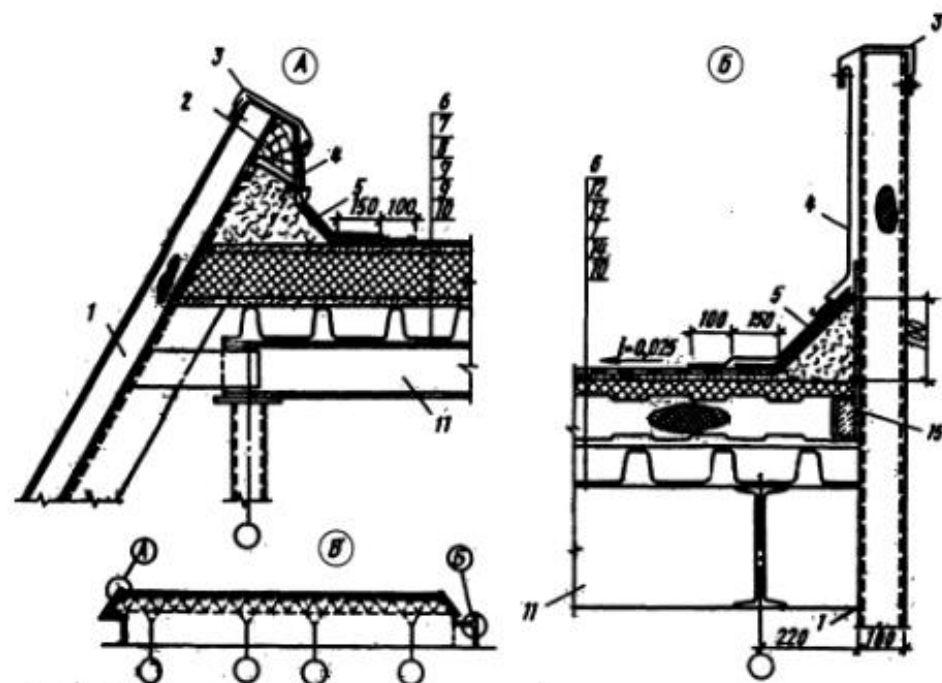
Узлы примыкания металлических панелей ограждения к конструкциям покрытия по структурной плите: А – наклонный фриз; Б – парапет вертикальной стены; В – схема покрытия; 1 – металлическая панель ограждения; 2 – деревянный антисептированный брус; 3 – алюминиевый парапетный профиль; 4 – фартук из оцинкованной стали; 5 – два дополнительных слоя рулонного кровельного материала; 6 – основной кровельный ковер (четыре слоя рубероида); 7 – асбестоцементный лист толщиной  $\delta=10$  мм; 8 – пенобетон, ( $\delta=50$  мм); 9 – паронизация (по периметру на ширину 800 мм); 10 – стальной профильный настил; 11 – стальные прогоны; 12 – цементно-песчаная стяжка ( $\delta=20$  мм); 13 – цементно-фибробетонные плиты; 14 – паронизация из рубероида.
